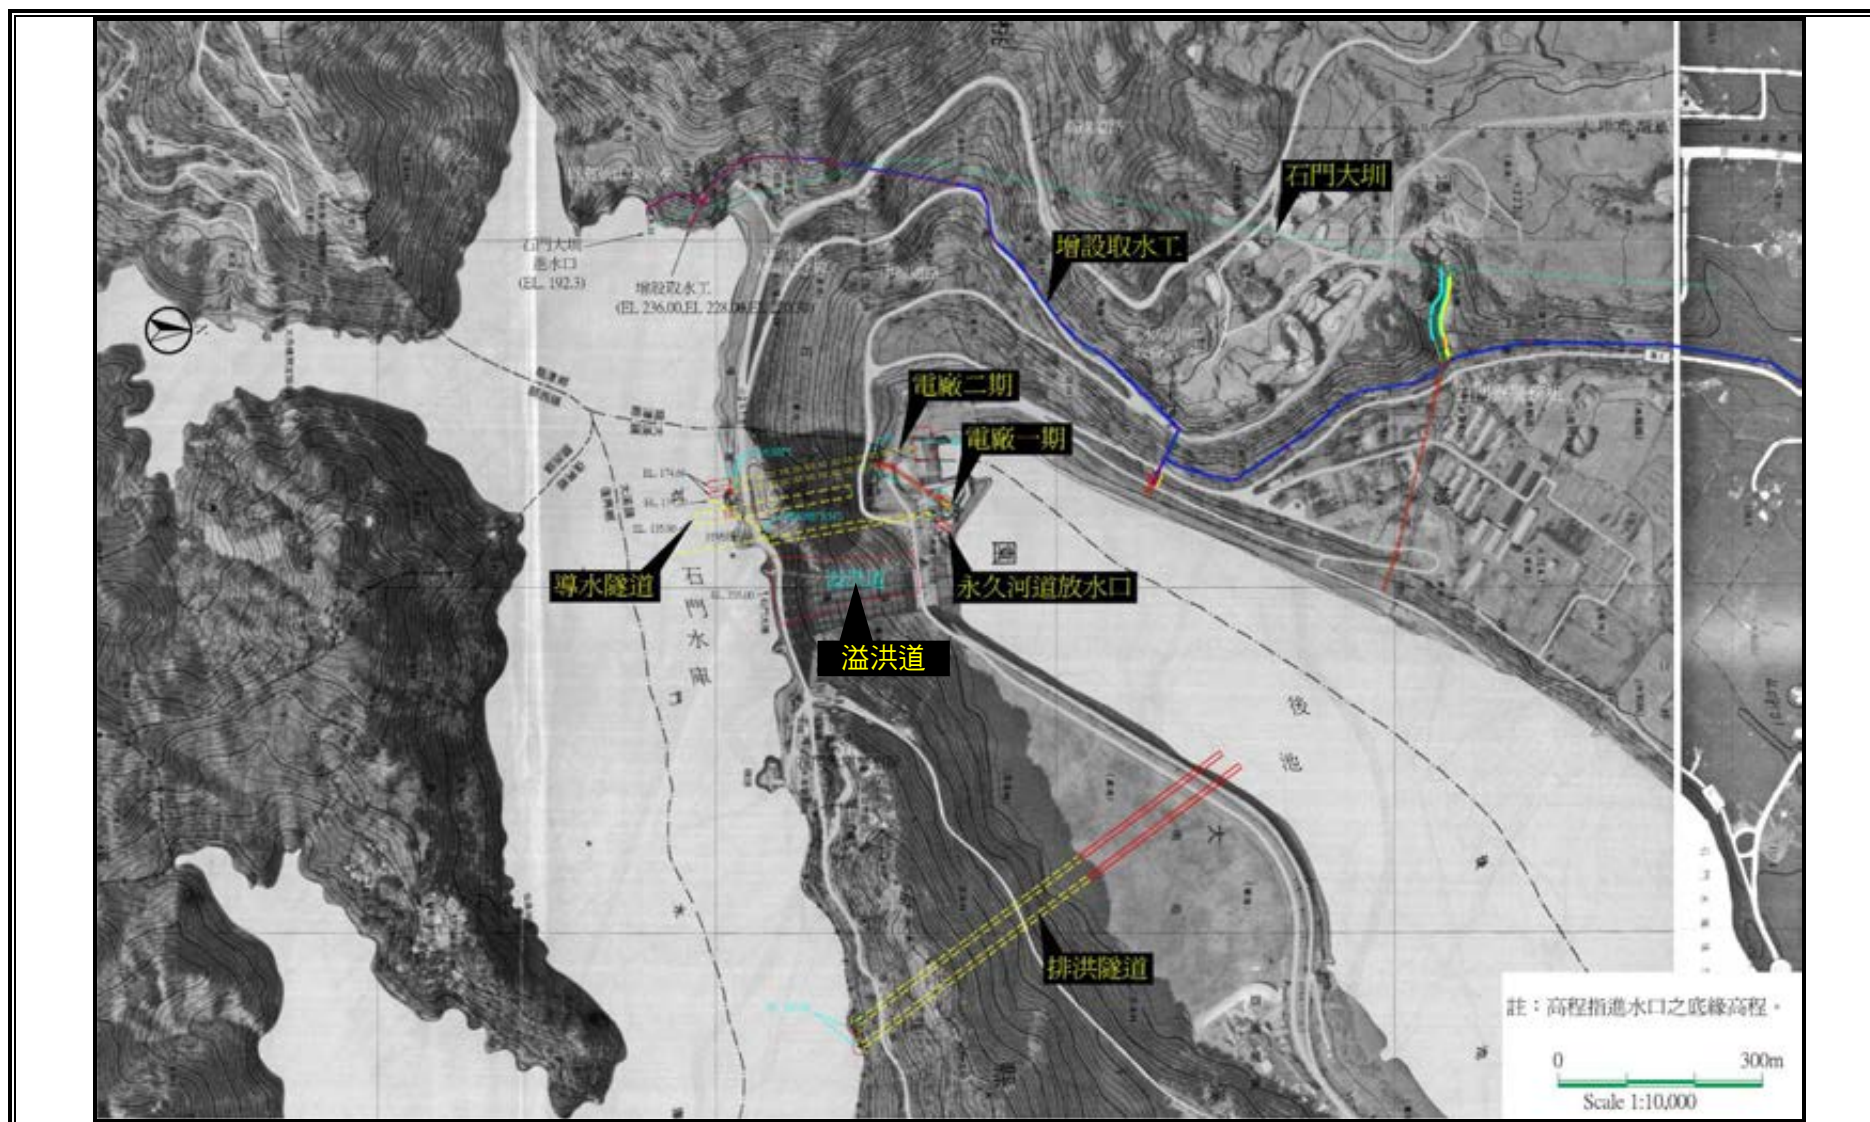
石門水庫既有及施工中之洩水結構平面位置圖
